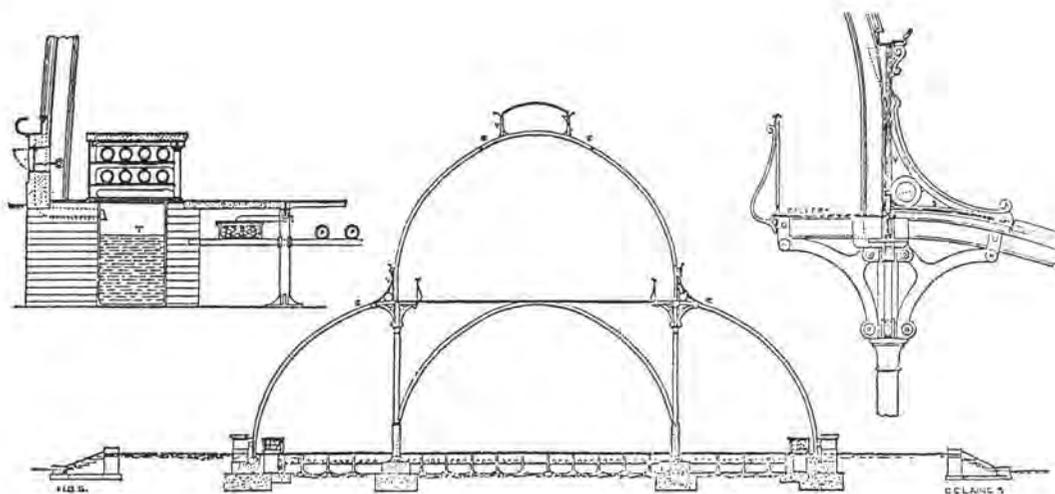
Palmenhaus in Kew, 1844, Querschnitt mit Details, aus /96/
